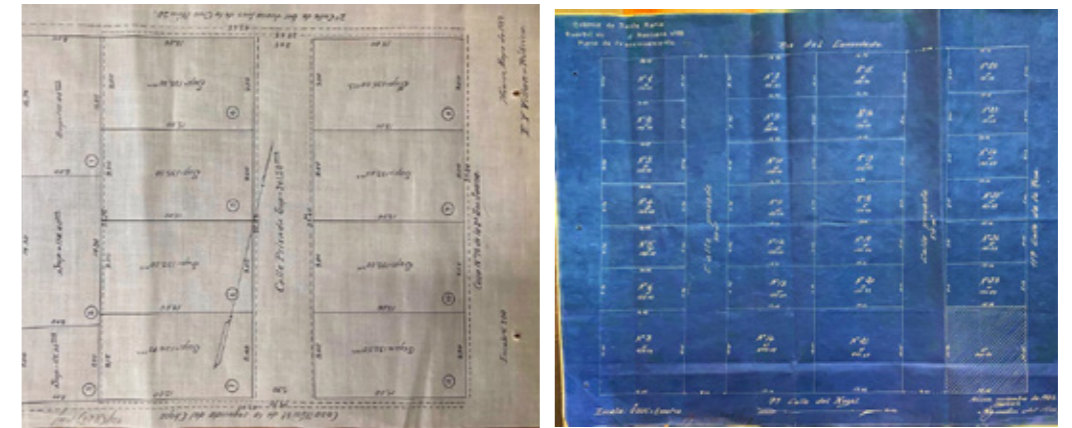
Planos de fraccionamiento para la manzana 159 y el terreno núm. 20 de la 2ª calle de Sor Juana: Archivo Histórico de la Ciudad de México, Planoteca, exp.15 y exp. 153 respectivamente.
